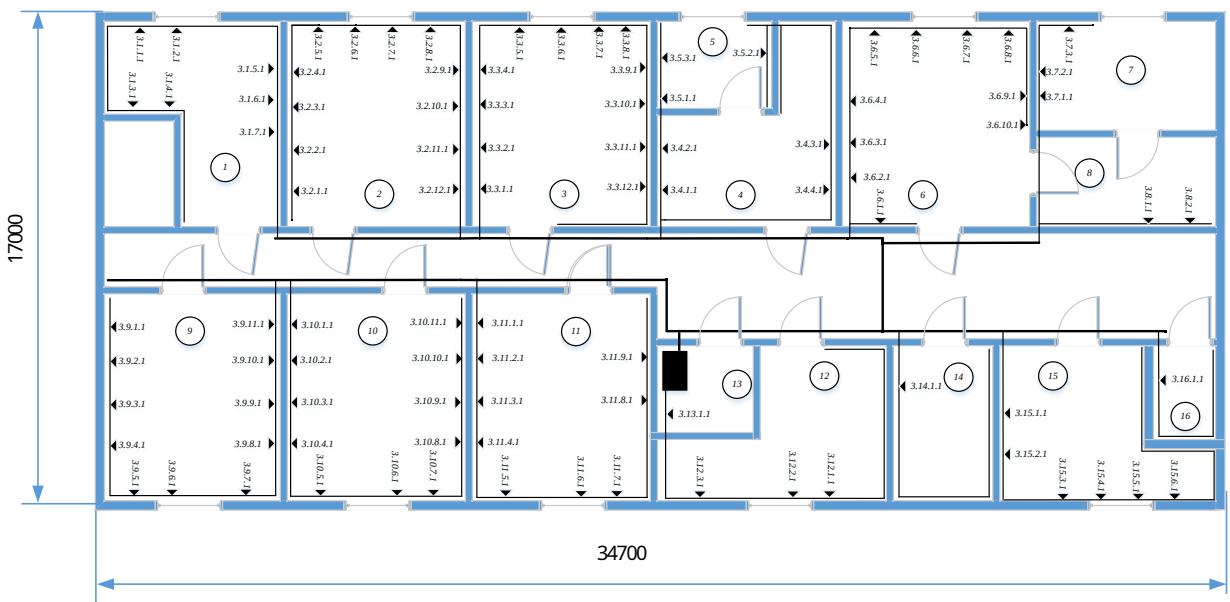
Достаточная зона покрытия для помещений 3-го этажа
